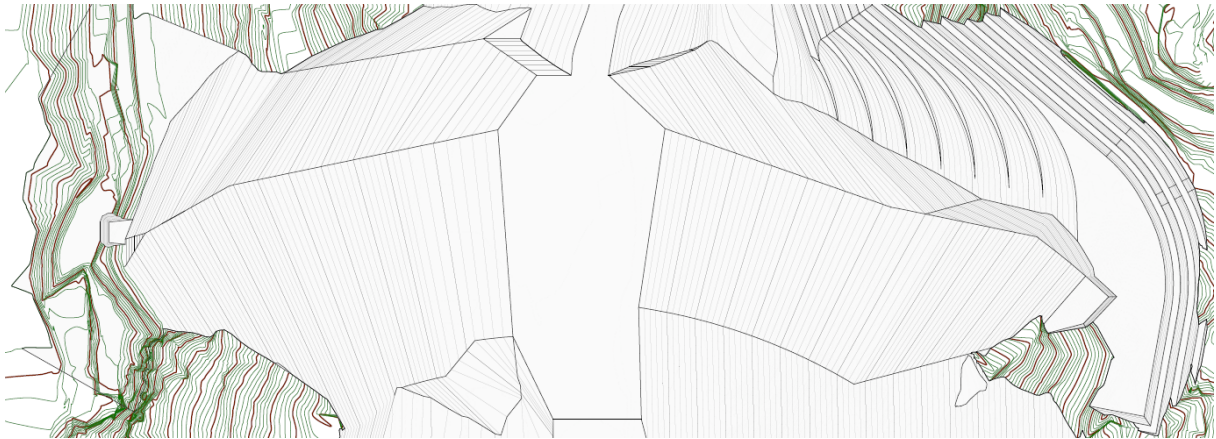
Vista en planta de la excavación de la presa. (Fuente: ANDRIAN [4])
